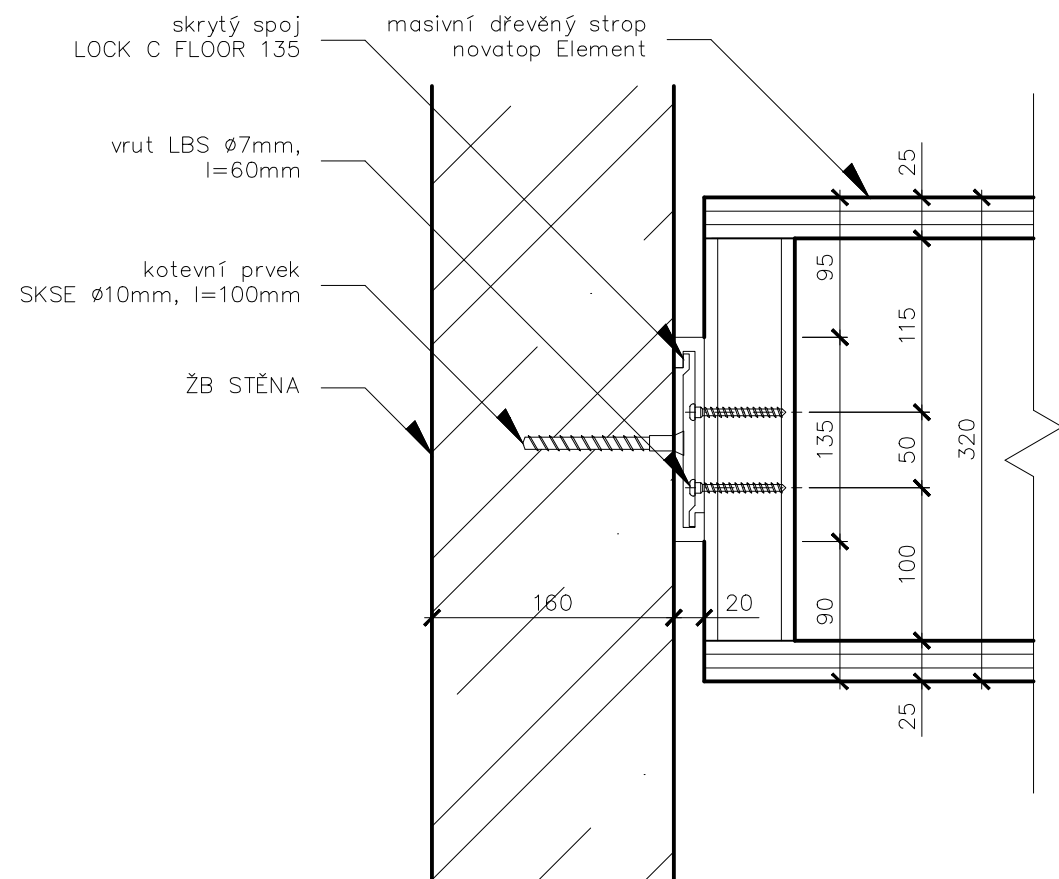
DETAIL NAPOJENÍ PANELU ŽB STĚNU JÁDRA
